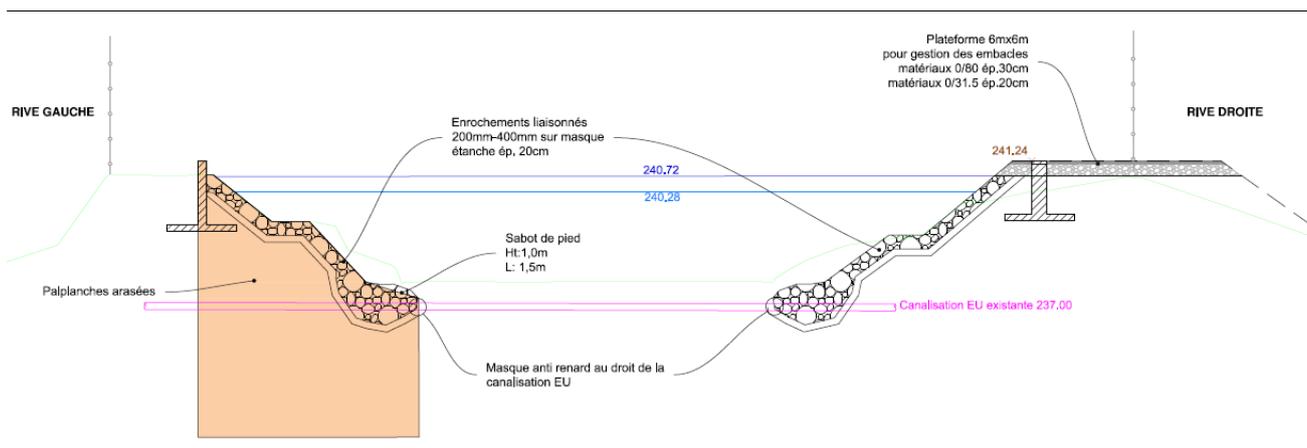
Coupe type 4: amont pont SNCF, masque amont et réhaussé par mur béton (Source: PRO Safège, avril 2018)
